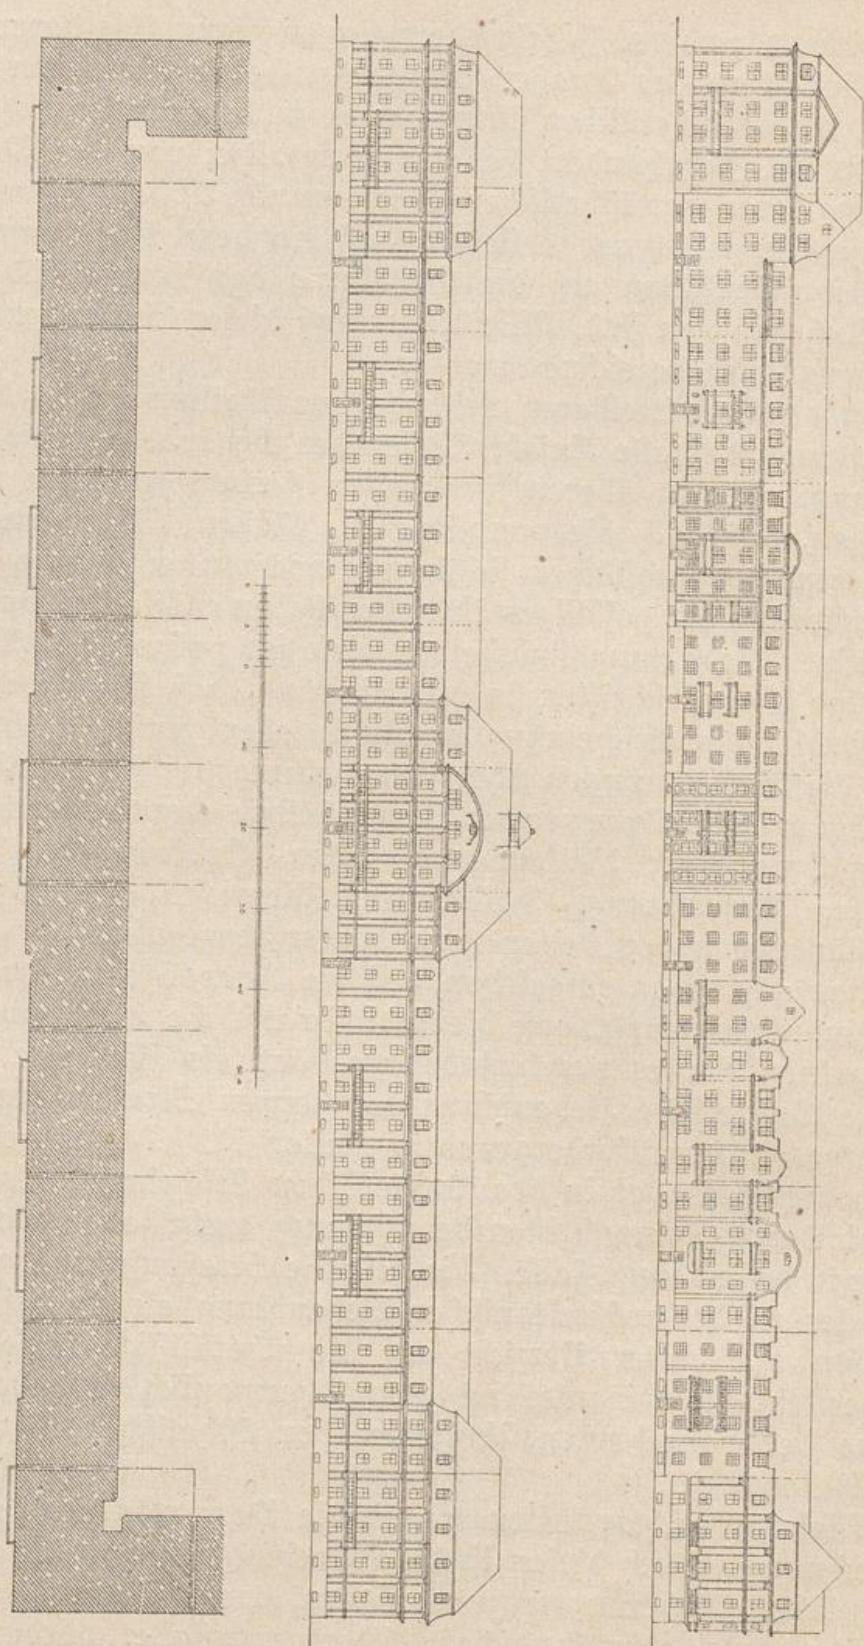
Bauabstossade mit Betonung des Einzelhauses.
